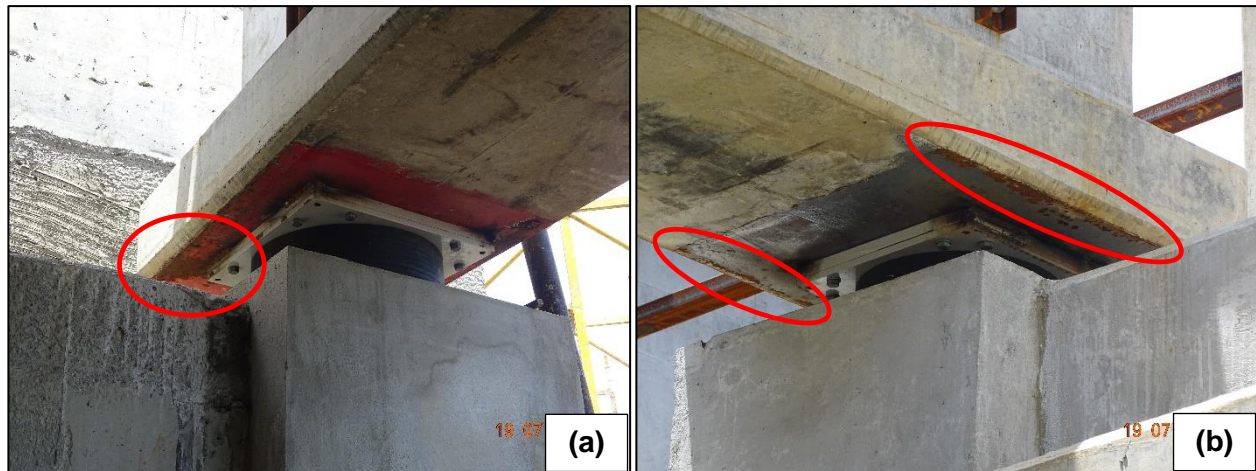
Desprendimientos y nidos de piedra puntuales observados en las columnas centrales de la Pila 56 del viaducto.
